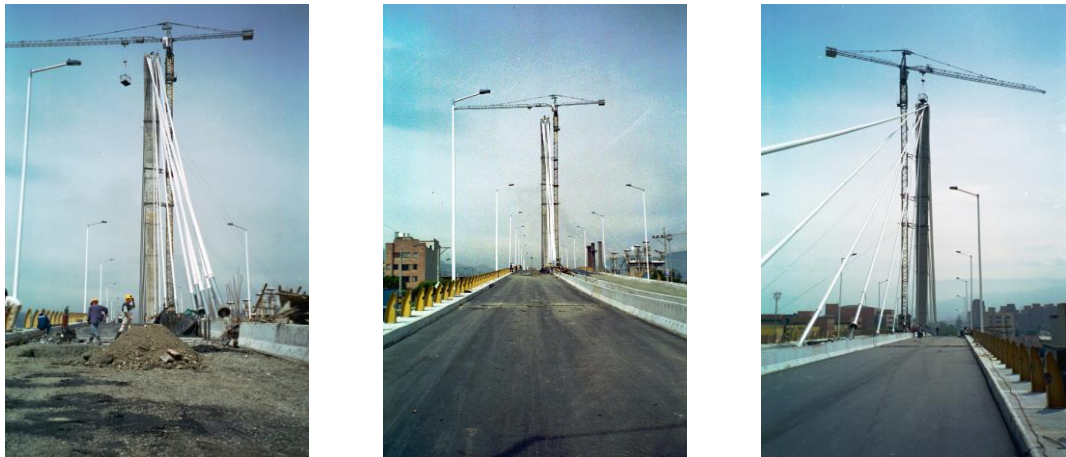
, 26, 27, 28, 29. Colocación de la carpeta asfáltica en el puente sobre la Avenida Las Vegas.
